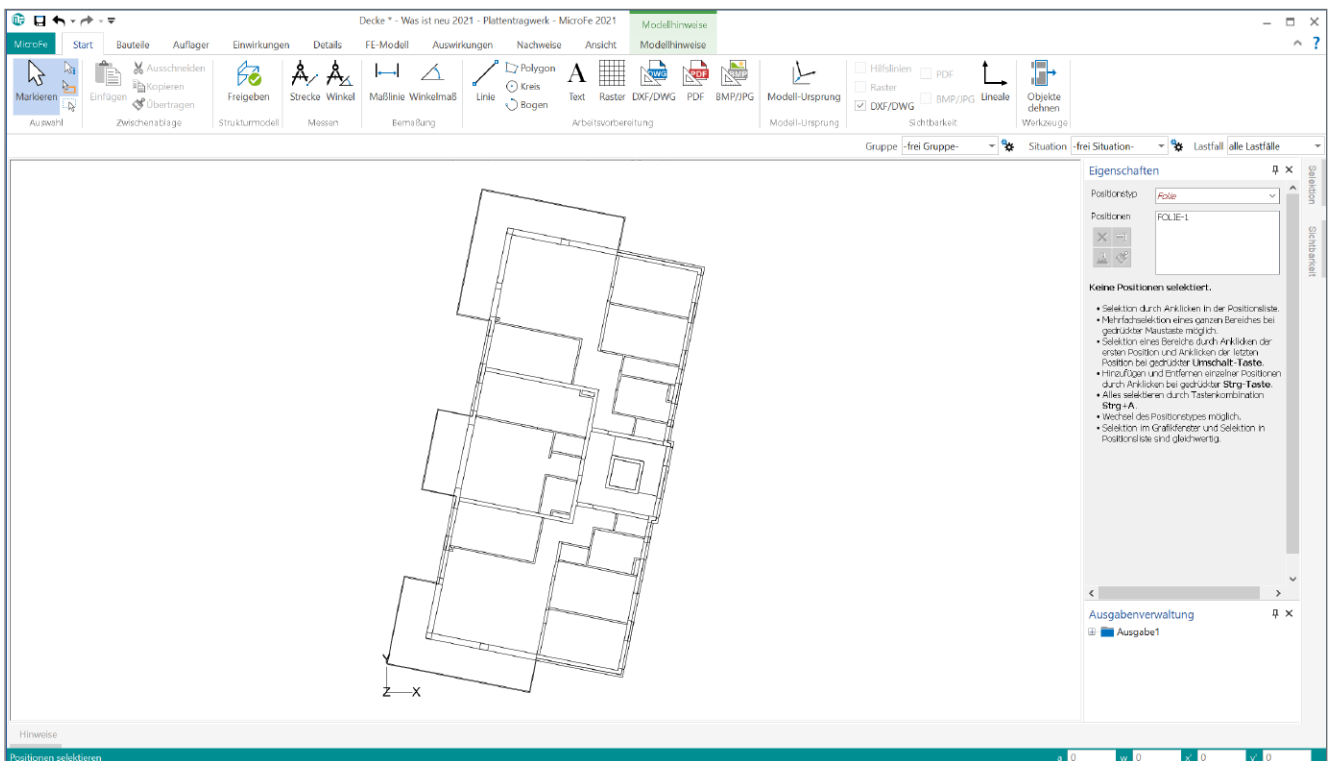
Grundriss aus DWG-Datei mit globaler Ausrichtung und Lage
